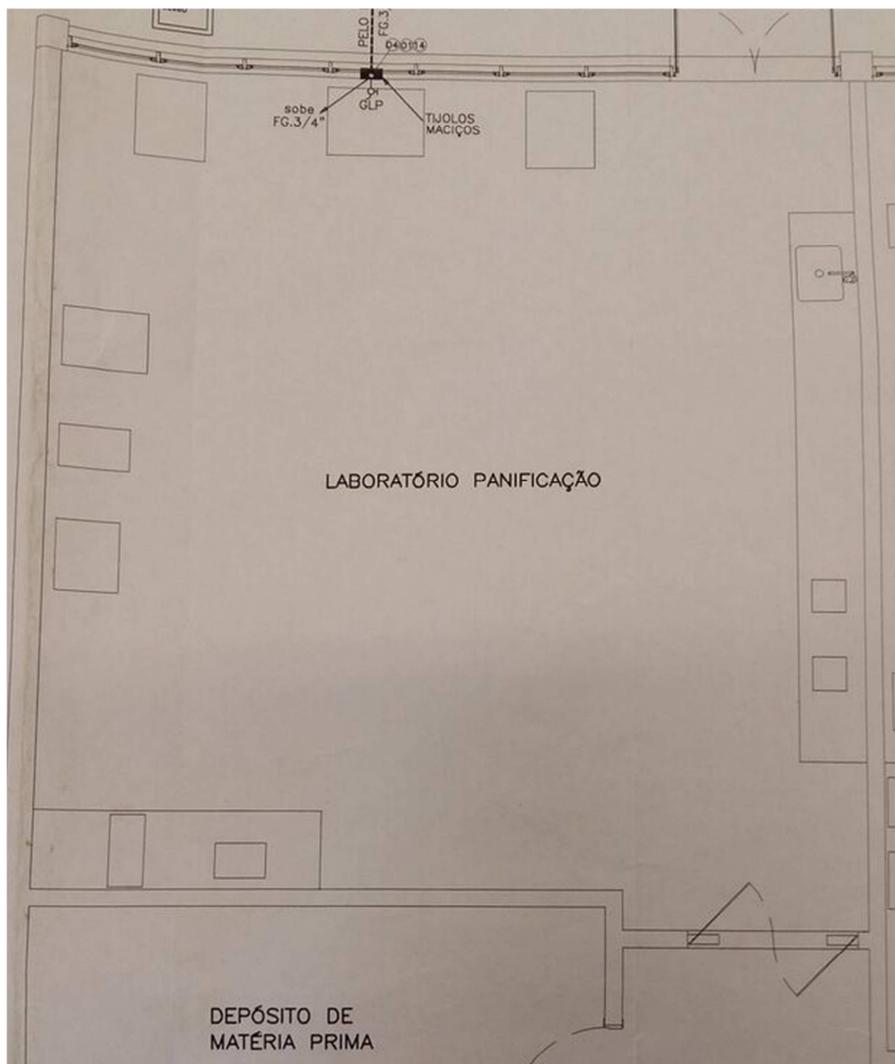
Planta baixa da Planta Piloto de Produtos Amiláceos
